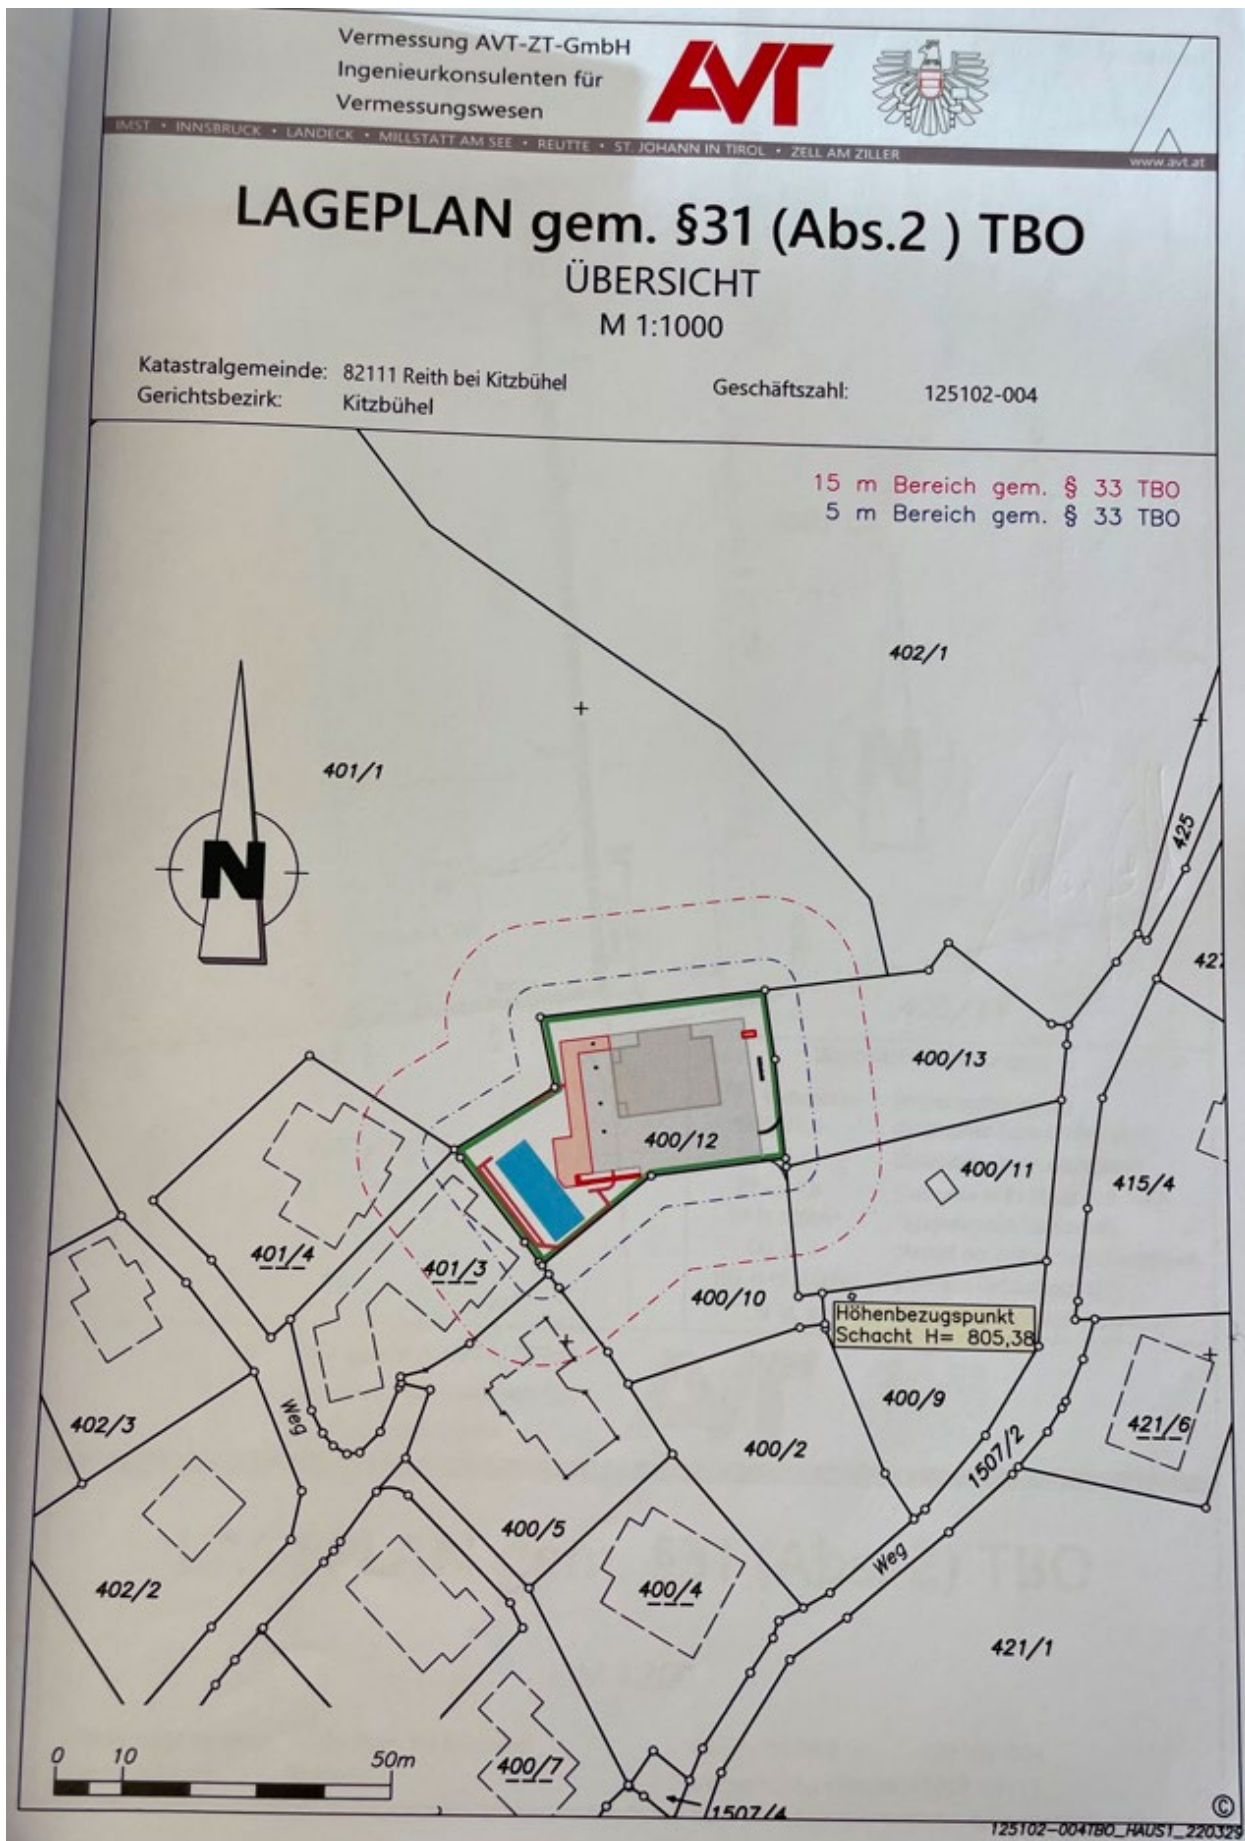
Lageplan gem. § 31 TBO-Übersicht
